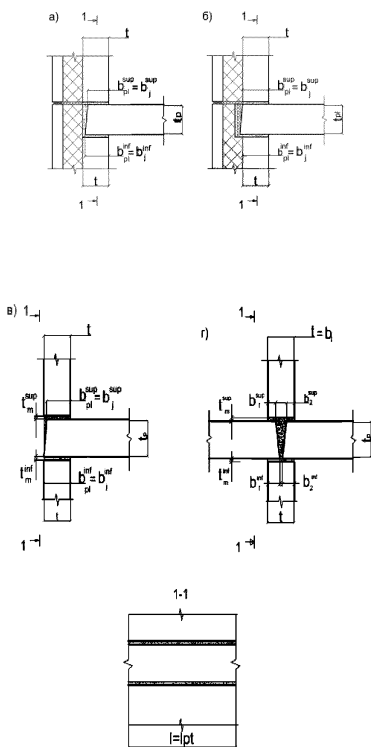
Платформенные стыки стеновых панелей: а, б – наружных трехслойных панелей; в – внутренних стеновых панелей односторонний; г – внутренних стеновых панелей двусторонний.
